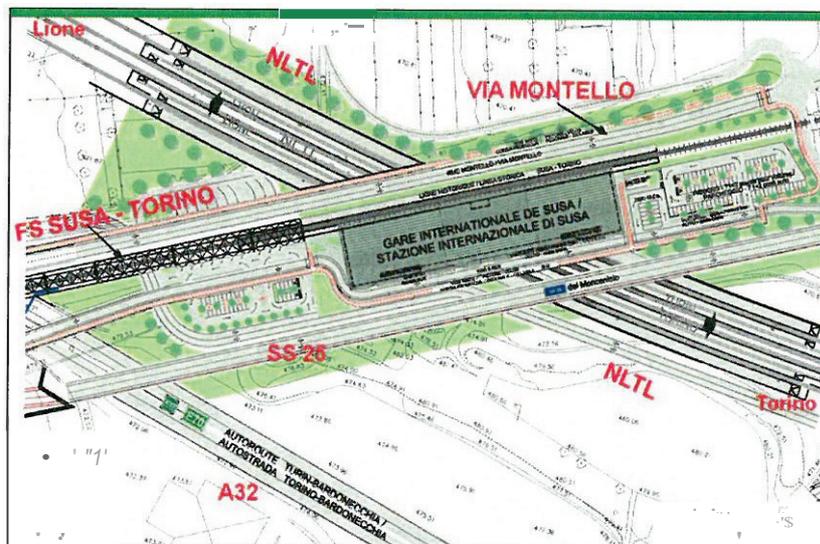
Schema ed inserimento della Stazione internazionale di Susa
